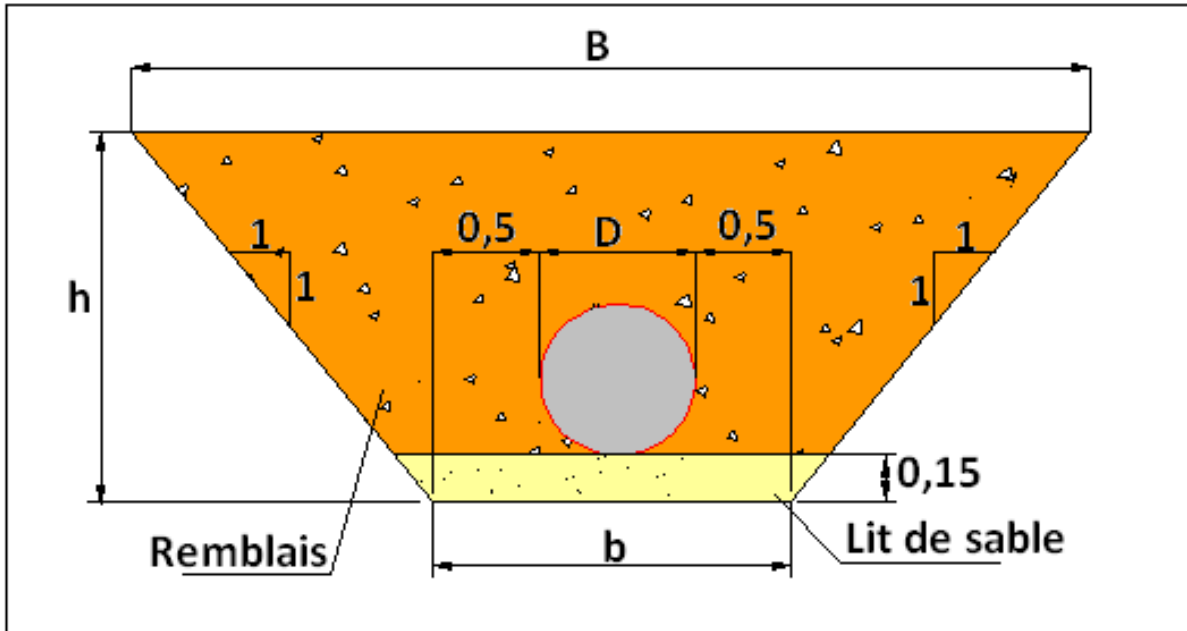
Coupes en travers de la tranchée de la conduite.
